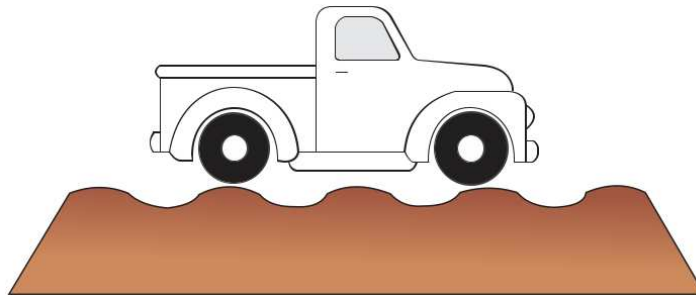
Corrugações da pista de rolamento com nível de severidade baixa.
